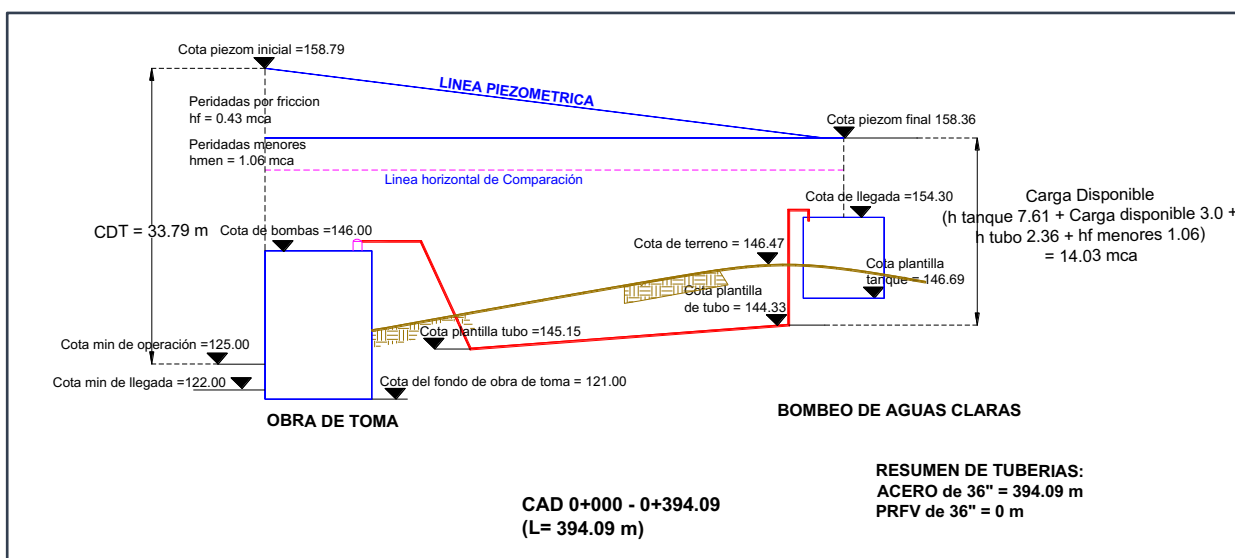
Piezométrica de la obra de toma a la planta potabilizadora, Alternativa 1
